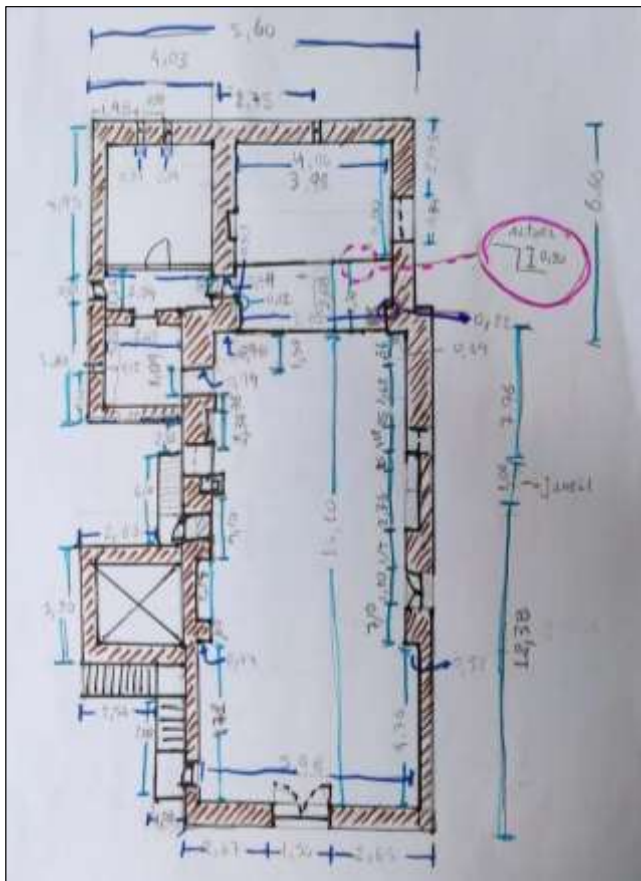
Esboço da planta baixa, realizado para notações do levantamento da igreja de Vila Marim.
